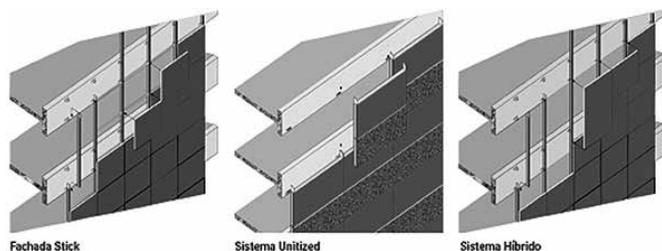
Sistemas de fachada de vidro dos tipos *stick*, unitizado e híbrido. (ROSSO, 2007).
